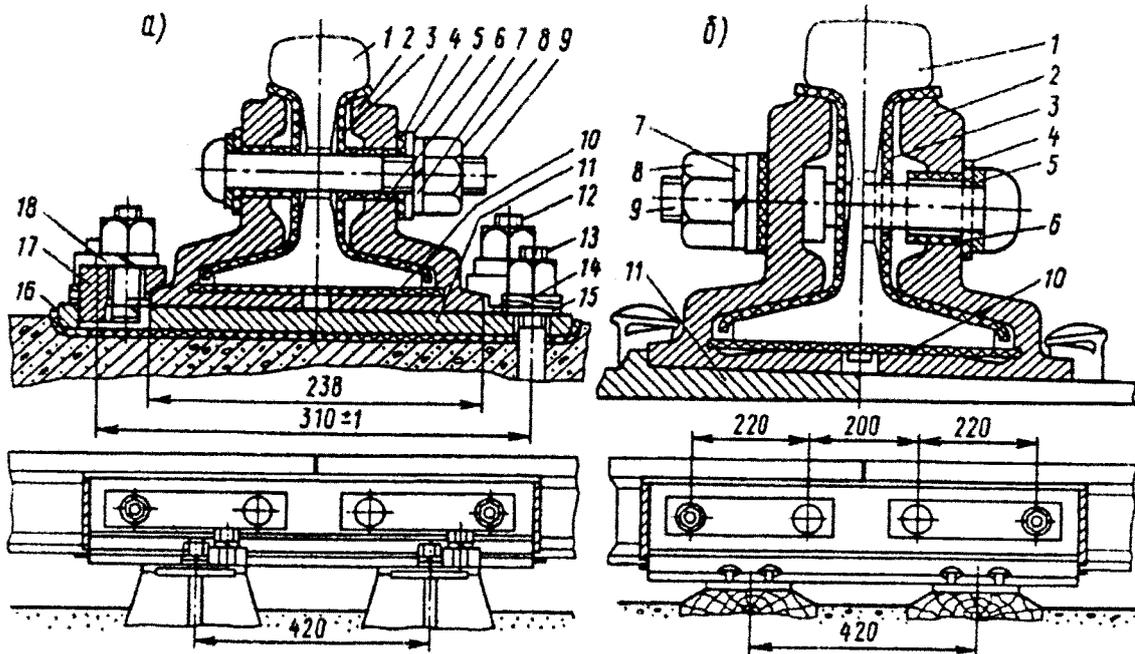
Изолирующий стык с объемлющими металлическими накладками: а – при железобетонных шпалах и креплении КБ; б – при деревянных шпалах с костыльным креплением; 1 – рельс; 2 – накладка; 3 – прокладка боковая; 4 – полиэтиленовая планка под болты; 5 – металлическая стопорная планка; 6 – втулка; 7 – пружинная шайба; 8 – гайка; 9 – стыковой болт; 10 – изолирующая прокладка под рельс; 11 – подкладка; 12 – клеммный болт; 13 – закладной болт; 14 – пружинная шайба; 15 – плоская шайба; 16 – прокладка под подкладку; 17 – клемма; 18 – шайба
